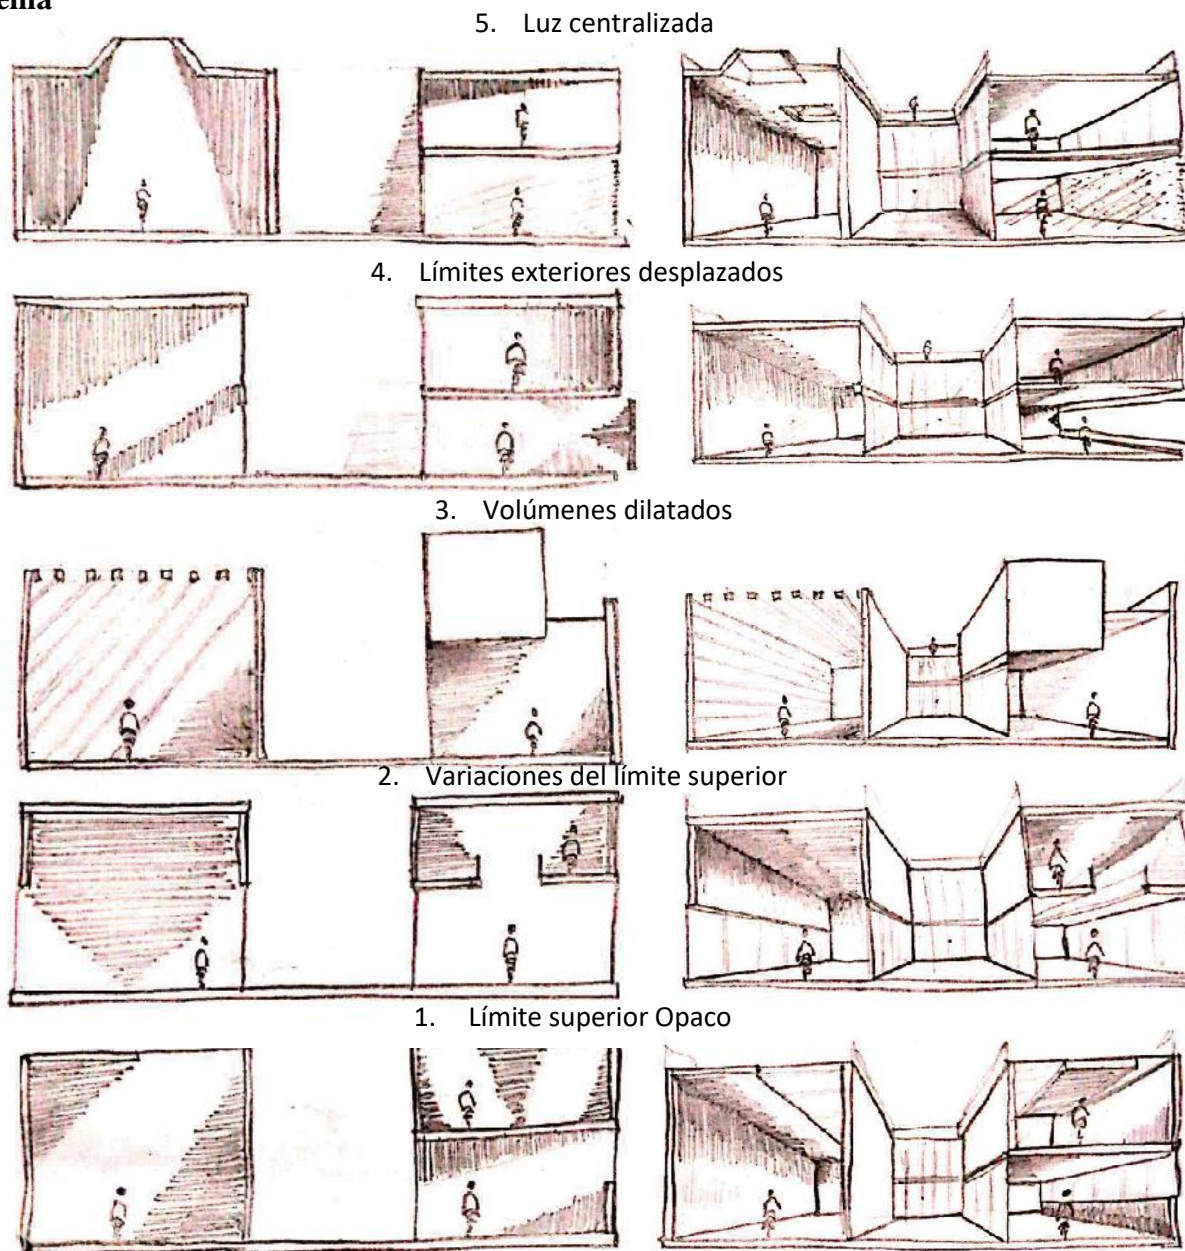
Esquemas del tema arquitectónico. Fuente: Autor
